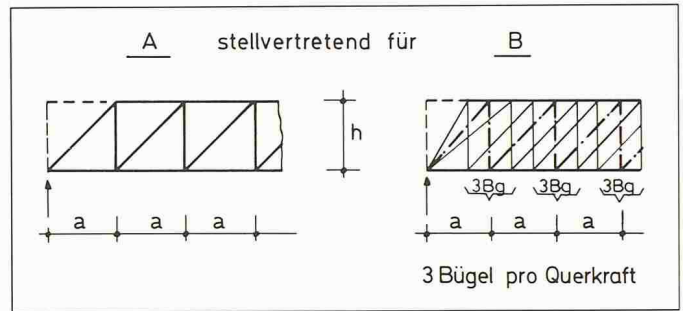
Stellvertretendes Fachwerk beim einfachen Balken
